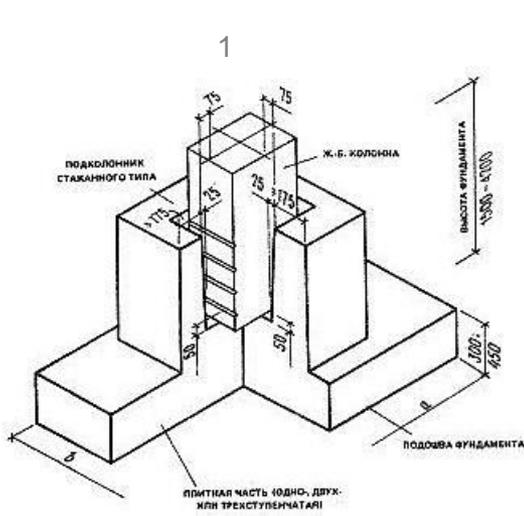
Сборные железобетонные фундаменты и опирание на них колонн каркаса
